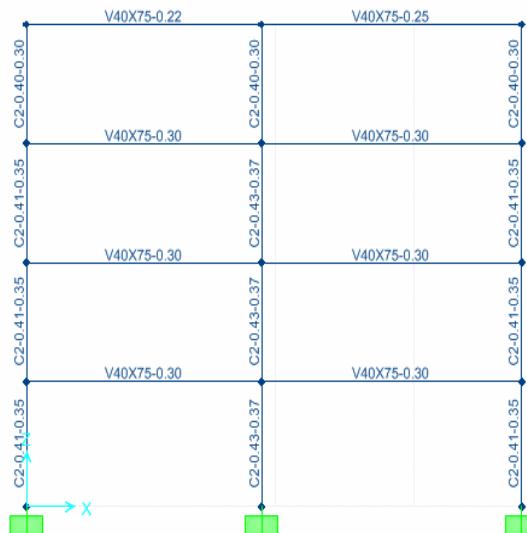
Pórtico del eje B indicando los factores de reducción de columnas y vigas en dirección X
